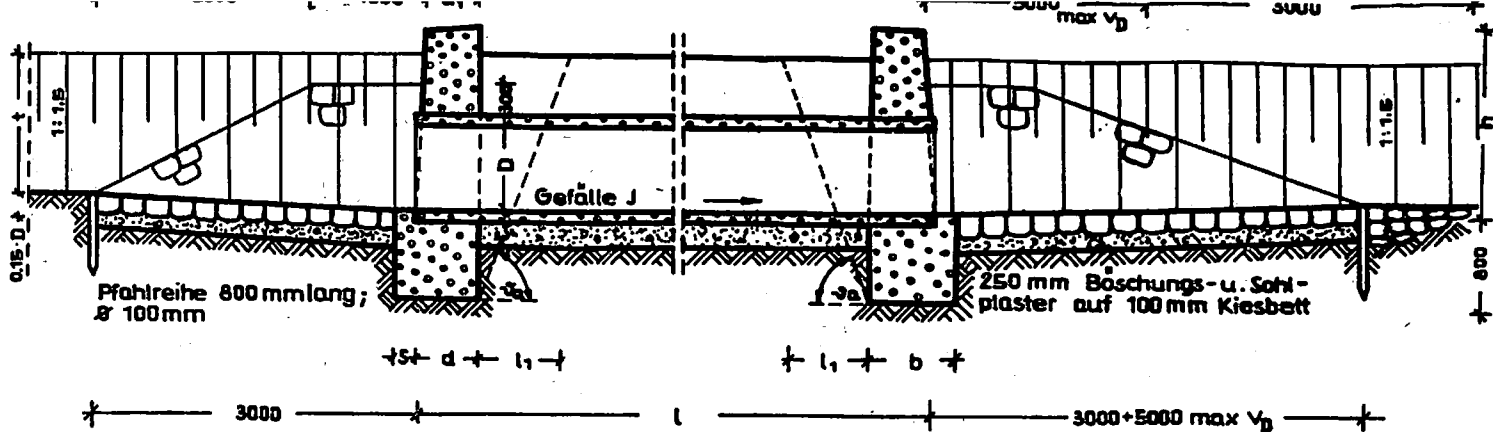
Rohrdurchlaß mit Stirnwänden aus Beton (nach Angebotsprojekt Nr. 1—04)
